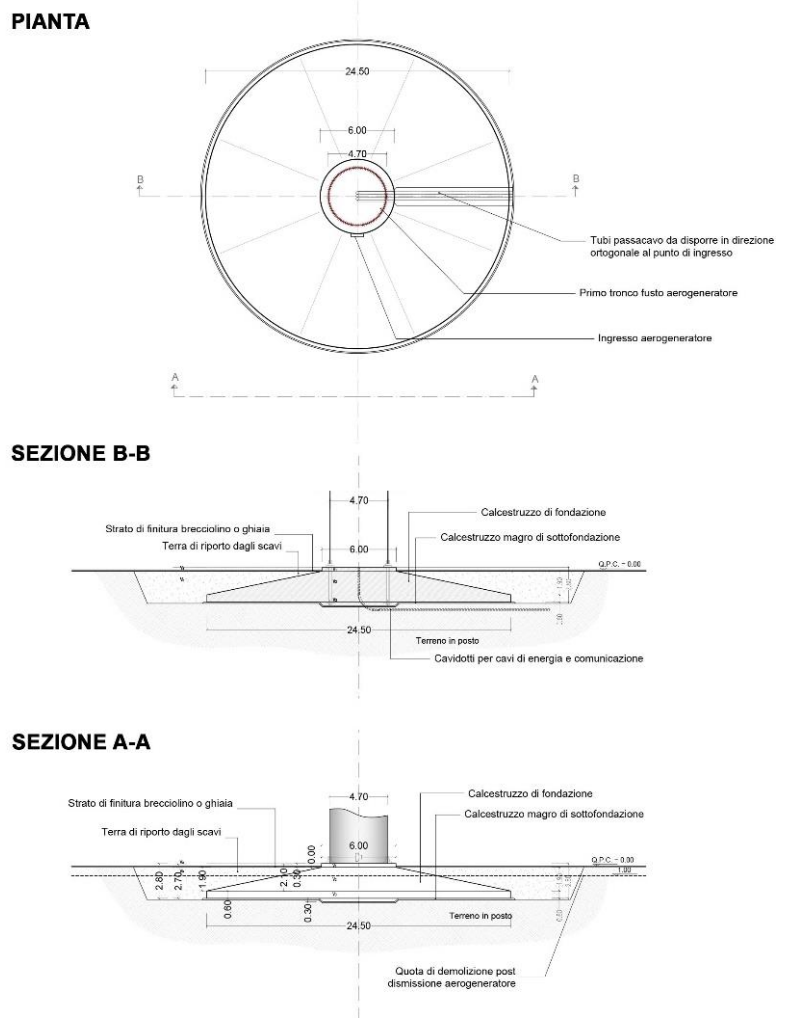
Pianta e vista della fondazione tipo dell'aerogeneratore
